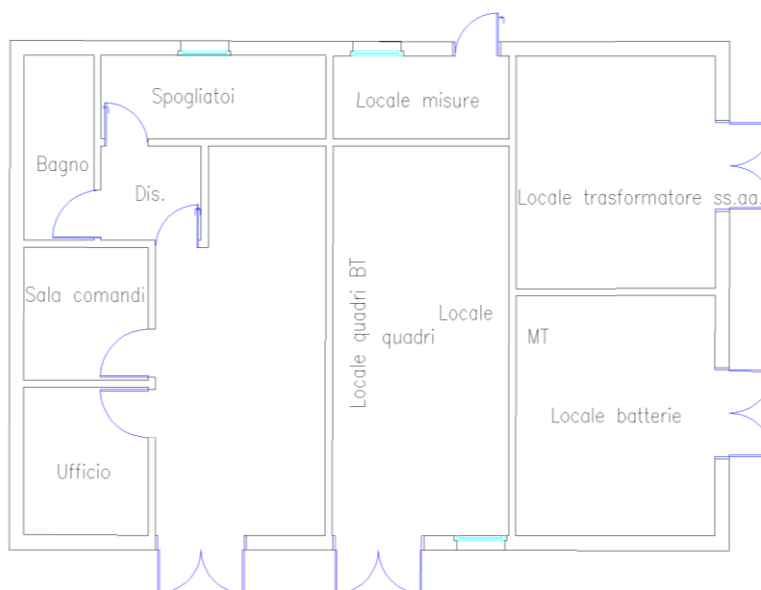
Planimetria secondo locale quadri MT della Stazione Utente
